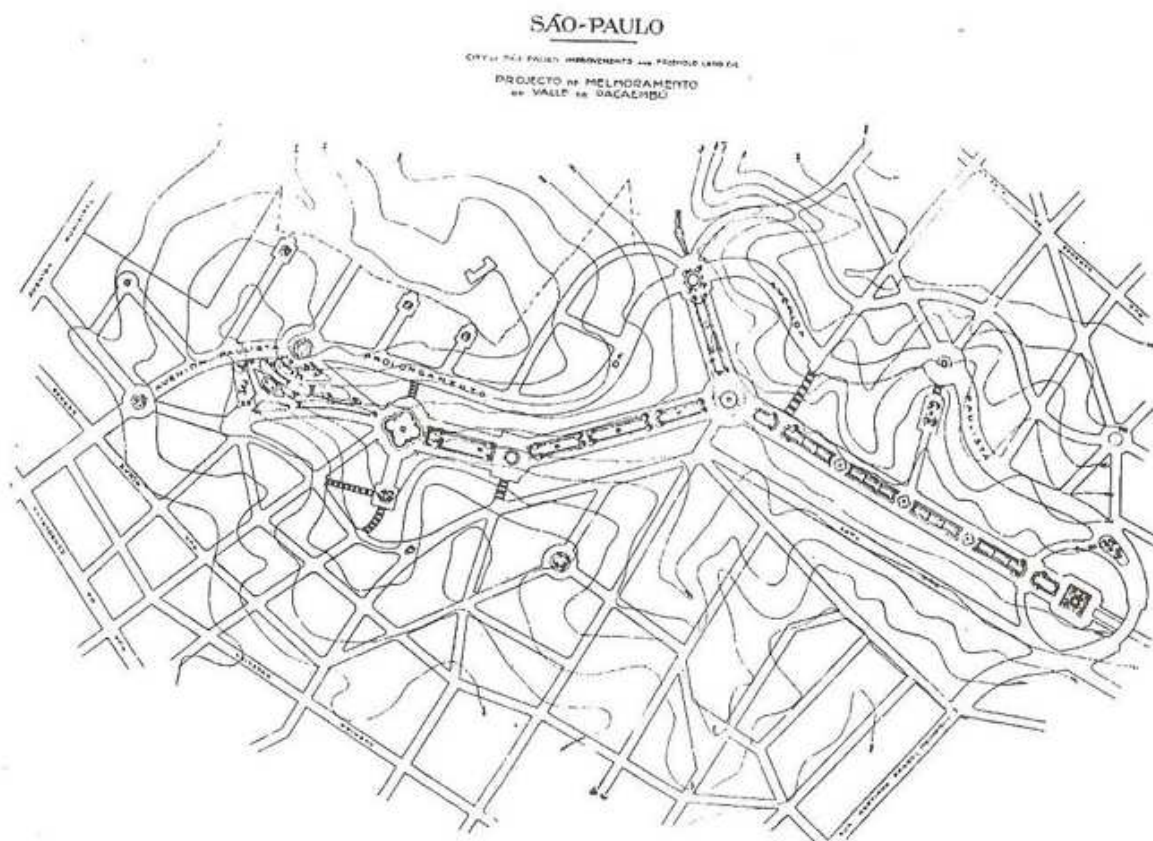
Proposta de Bouvard para o arruamento do Pacaembu, realizado por encomenda da Cia City, em 1912. Fonte: FREIRE, Victor. A Planta de Bello Horisonte (a propósito da Cidade Salubre). *Revista Polytechnica*. São Paulo, V.9, N.52, p. 159-174, jan.1916.
